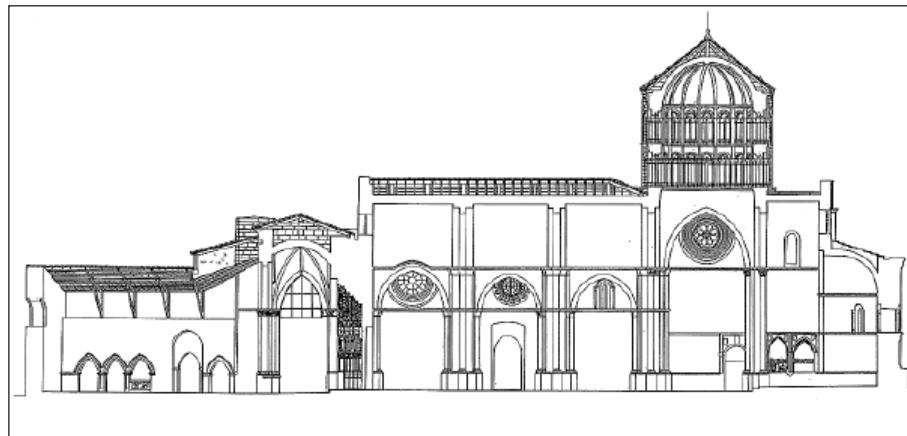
, 31b 31c. Alzado exterior, sección, y planta del cimborrio de la catedral vieja de Salamanca. © Fundación Santa María la Real / G. Lalanda.
